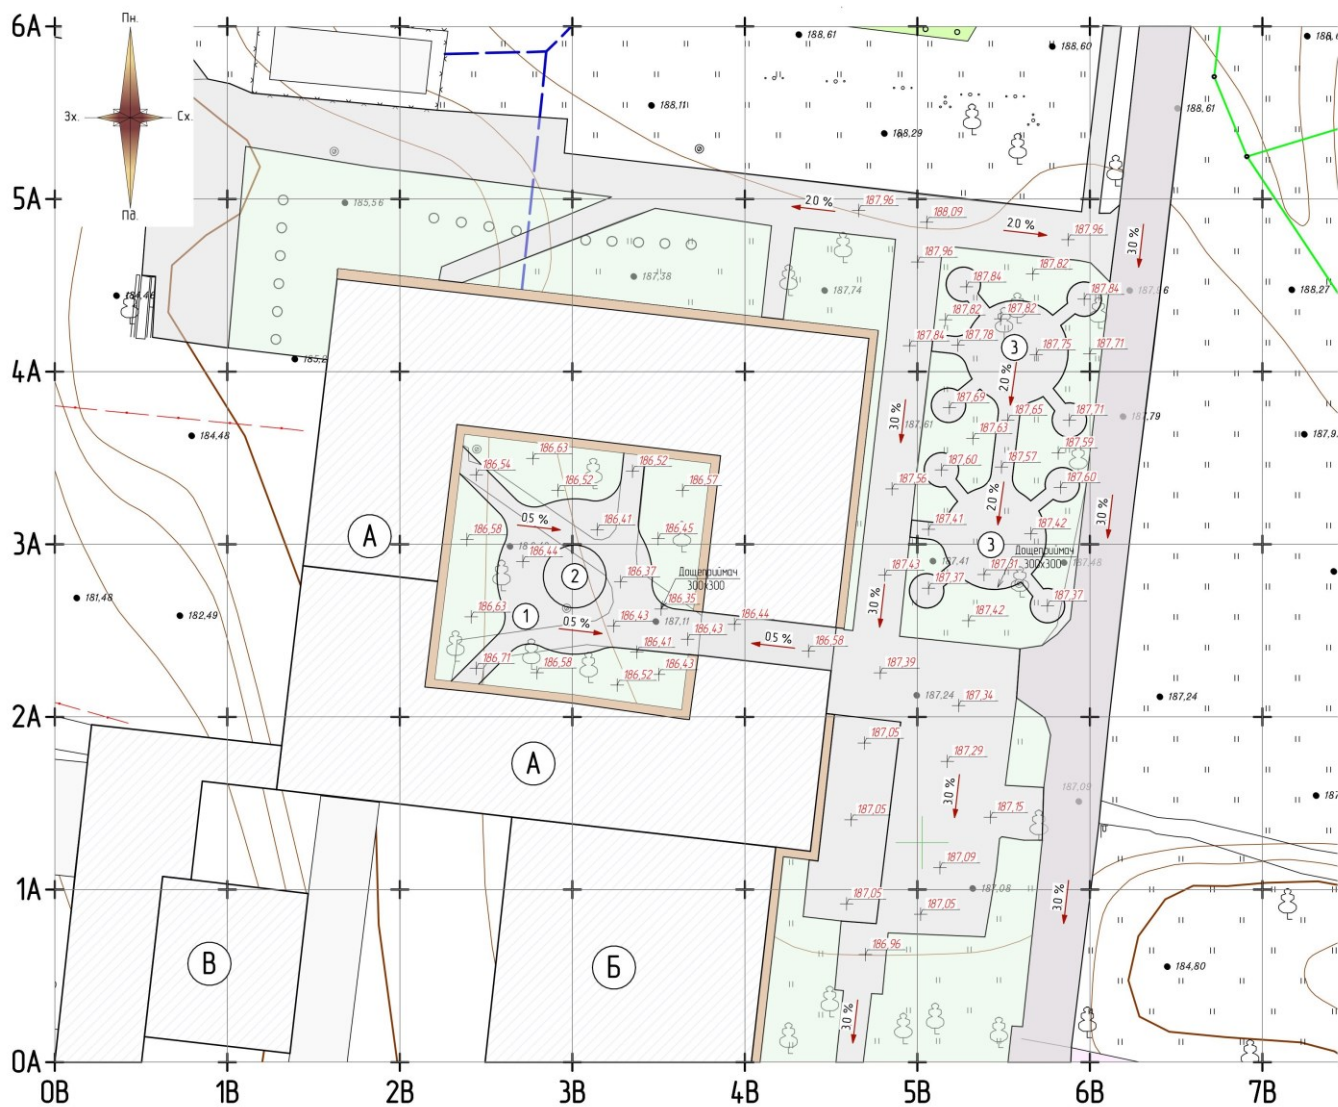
Схема вертикального планування території (фрагмент 1)
